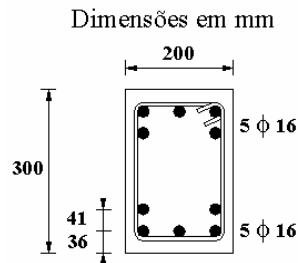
Seção transversal do pilar do pórtico de Alva
